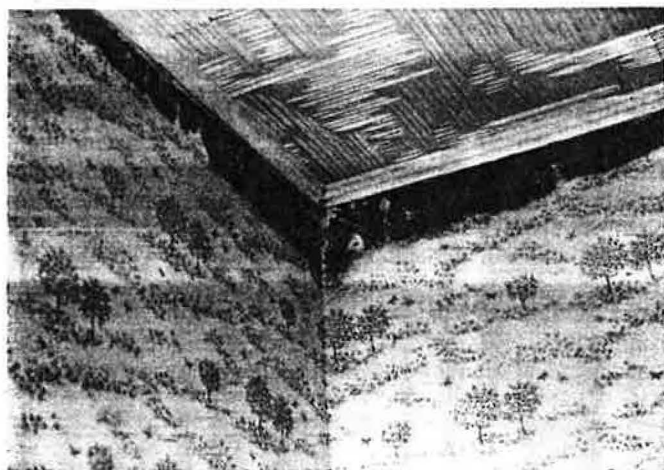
Photographische Aufnahme einer Außenwanddecke mit Schimmelpilzbefall, nach [6]
